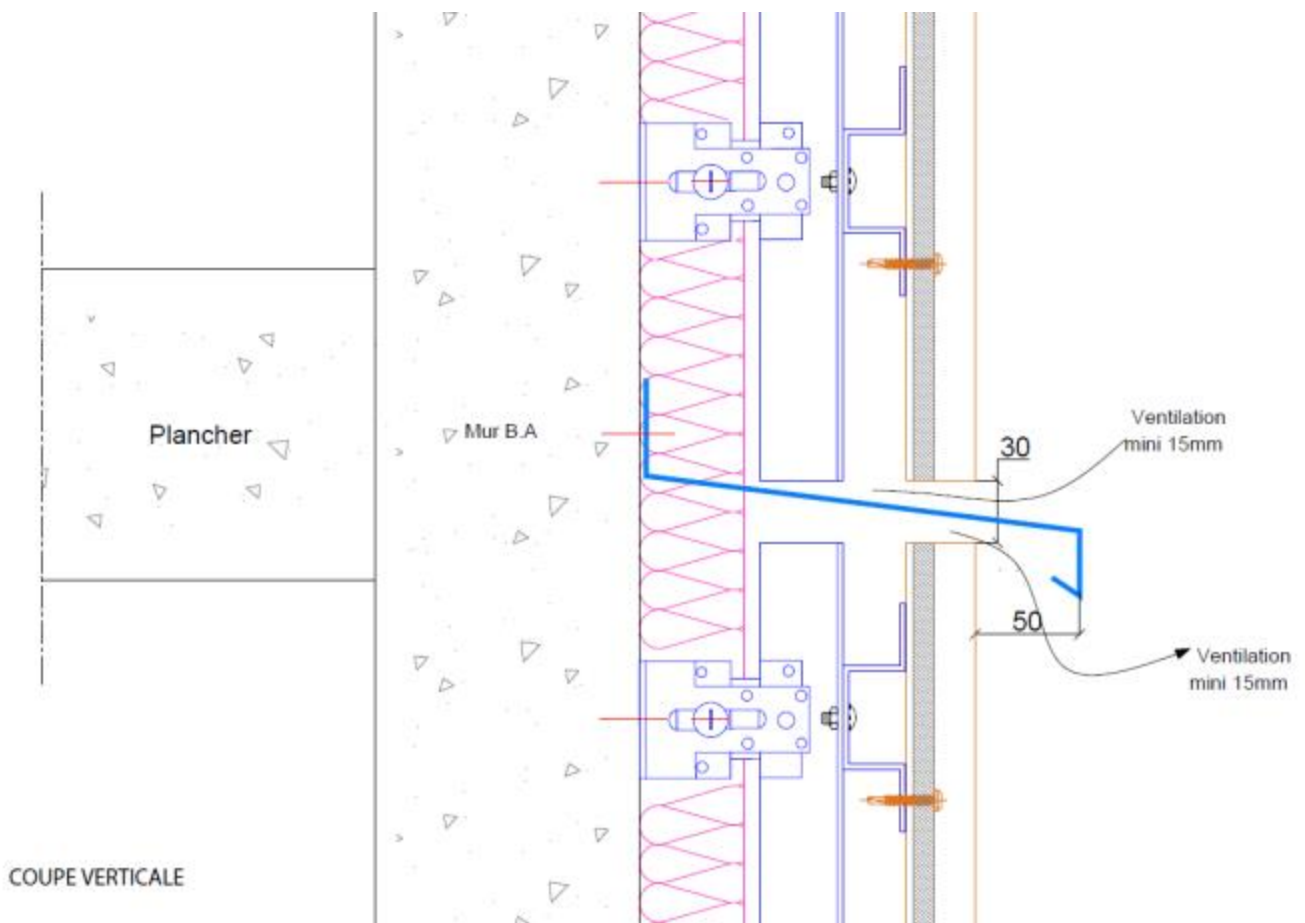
Fractionnement de l'ossature au droit de chaque plancher sur béton
